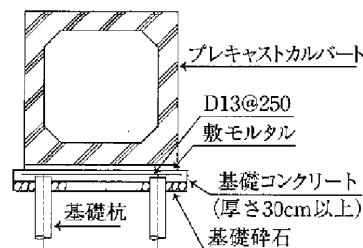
プレキャストコンクリート暗きよの杭基礎
